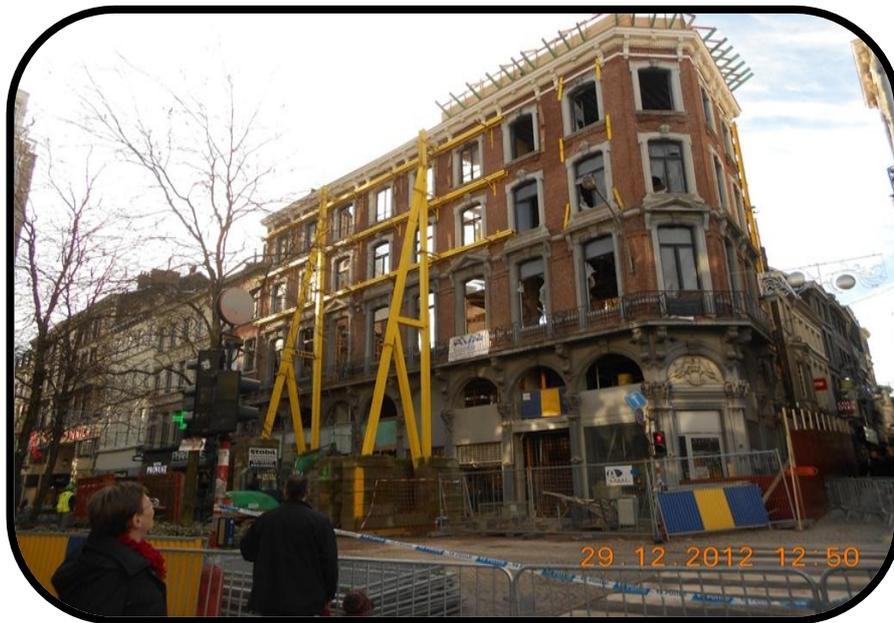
Restauration d'une construction ancienne avec préservation de la façade principale (préservation du patrimoine ancien) Bruxelles.
